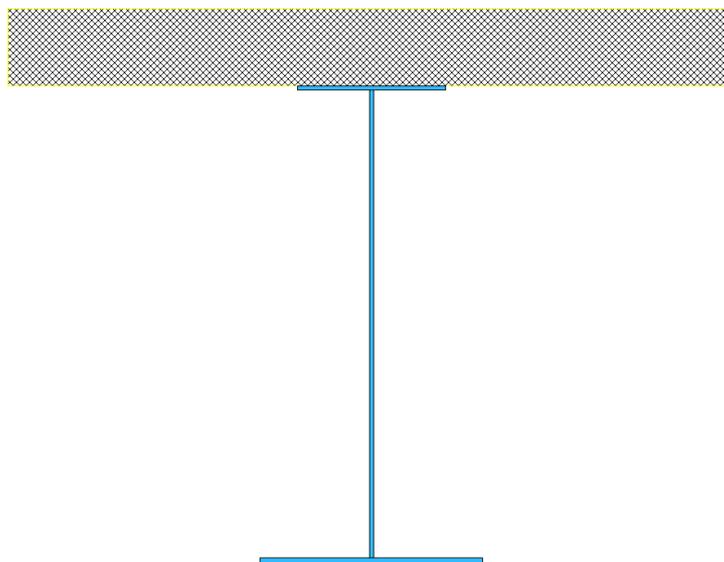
Geometria generica della sezione mista acciaio-calcestruzzo
